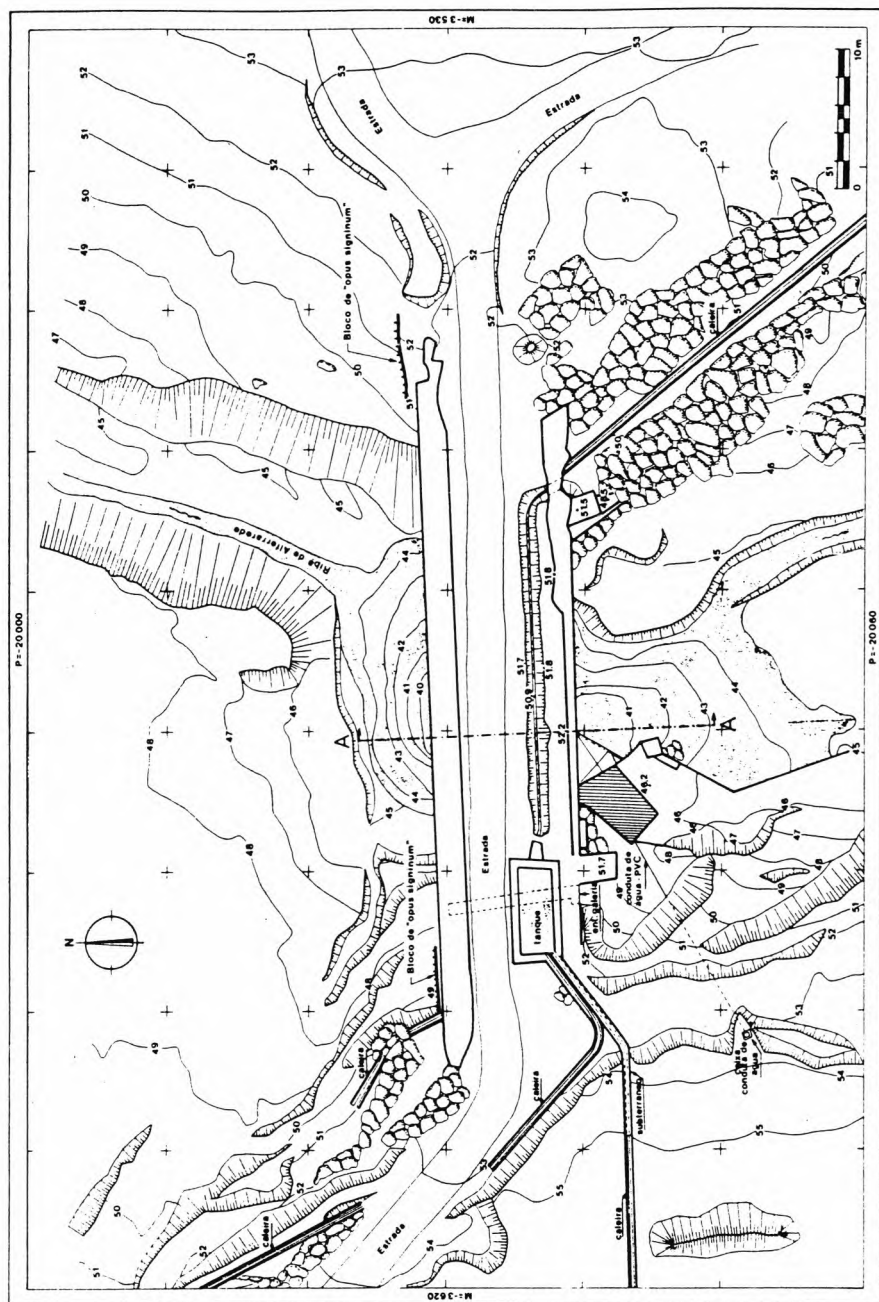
Barragem de Alferrade (Abrantes). Planta da barragem
